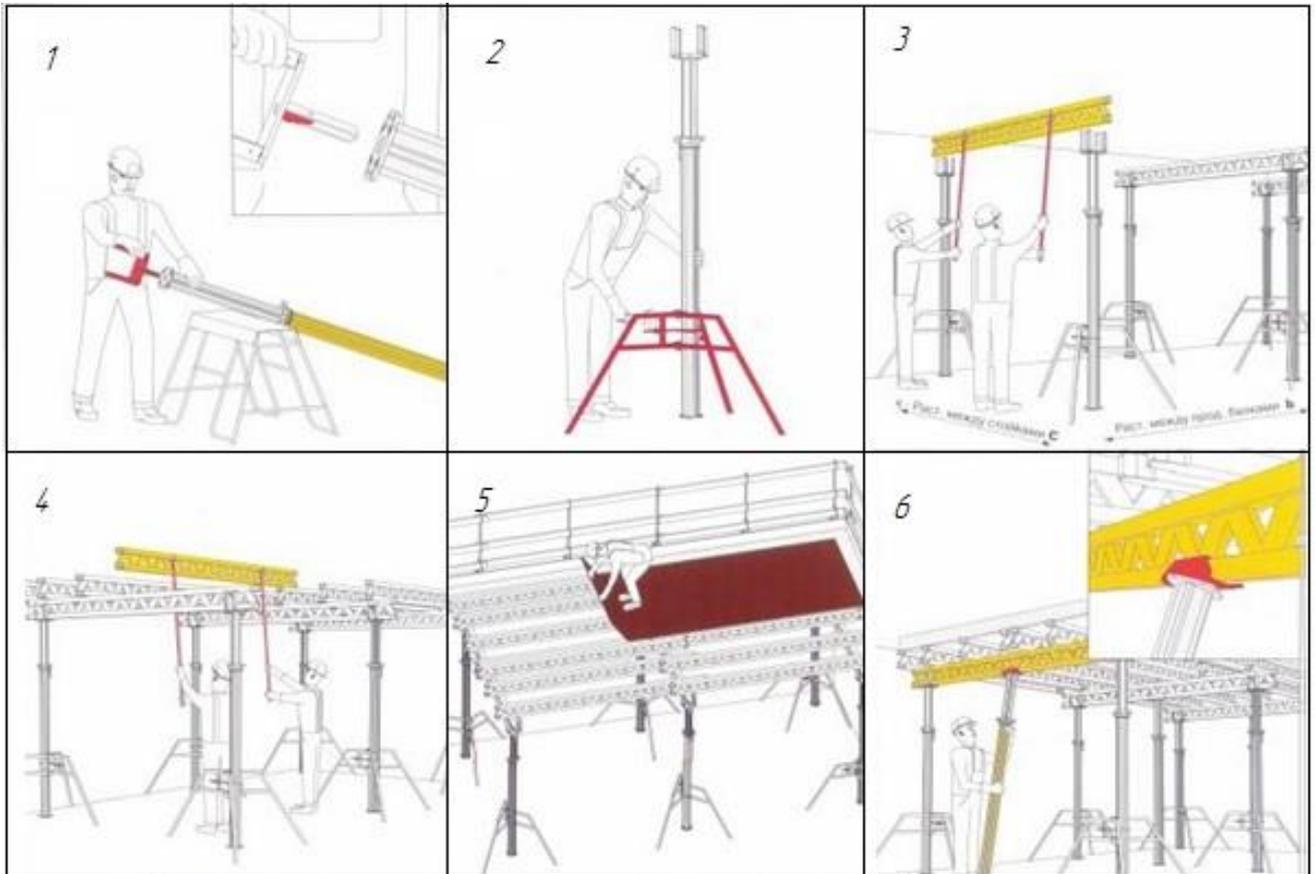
Схема технологии выполнения работ при устройстве монолитного железобетонного перекрытия
